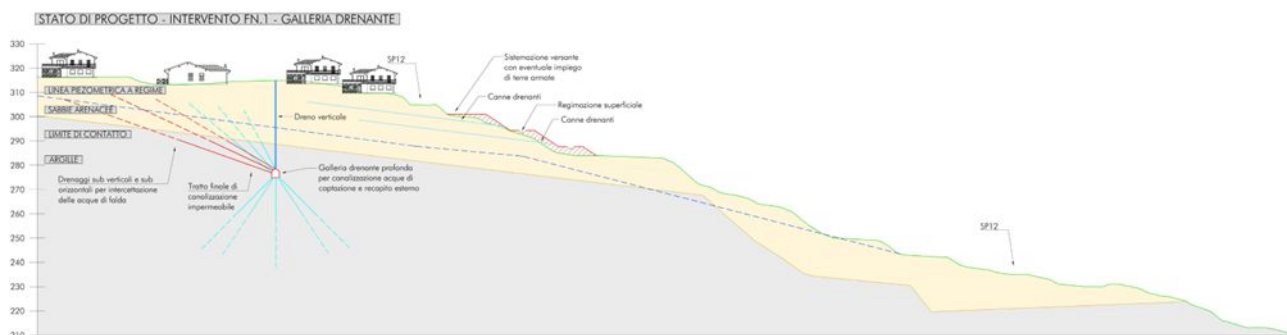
Sezione tipologica del versante in frana con galleria drenante profonda nelle argille.
